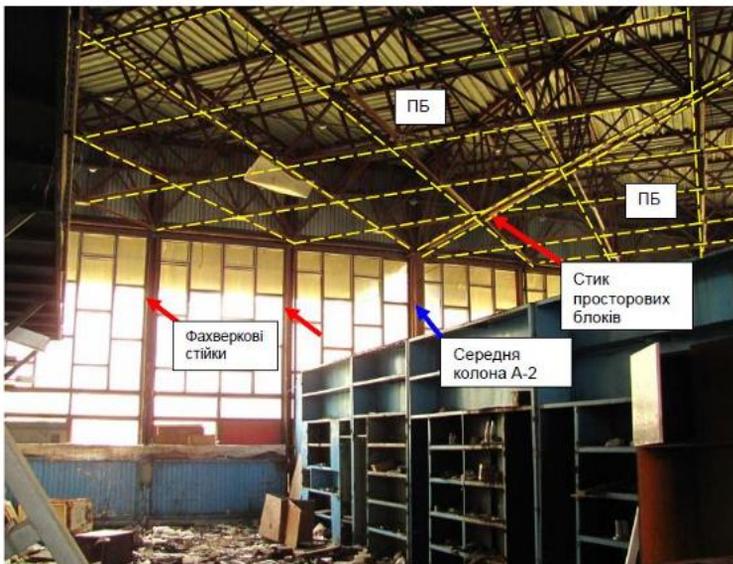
Плоскі ферми з кроком між фермами 2121мм та під кутом 45°. Обпирання ферм на фажверкові стійки з кроком 3м.
